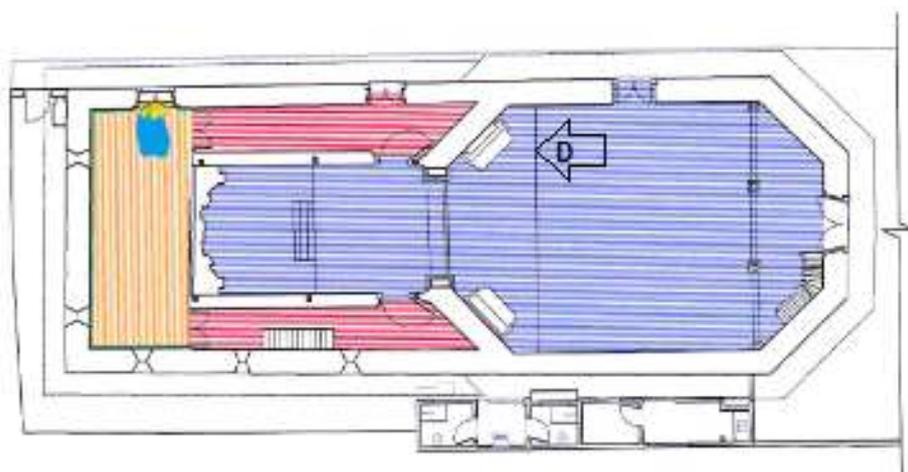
Vista D - Retábulo lateral direito- Planta pavimento inferior Capela Sem escala.
